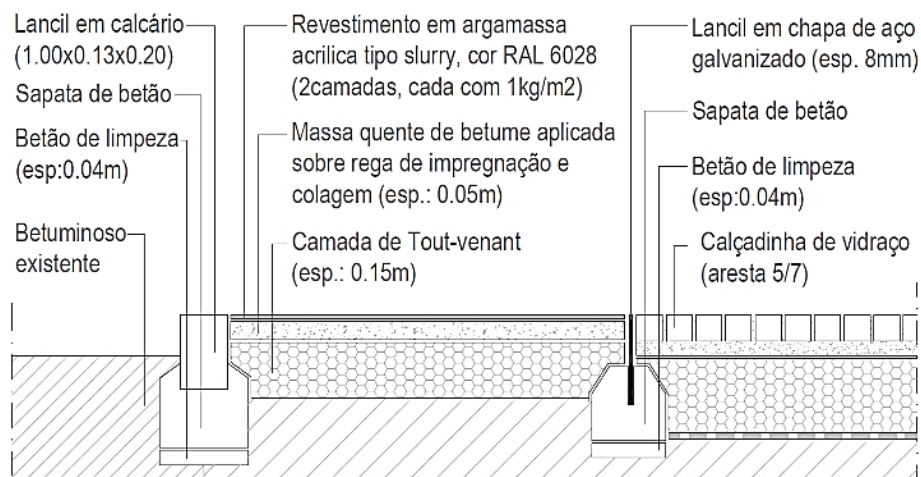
Corte do Pavimento em cubo de vidro [13]
